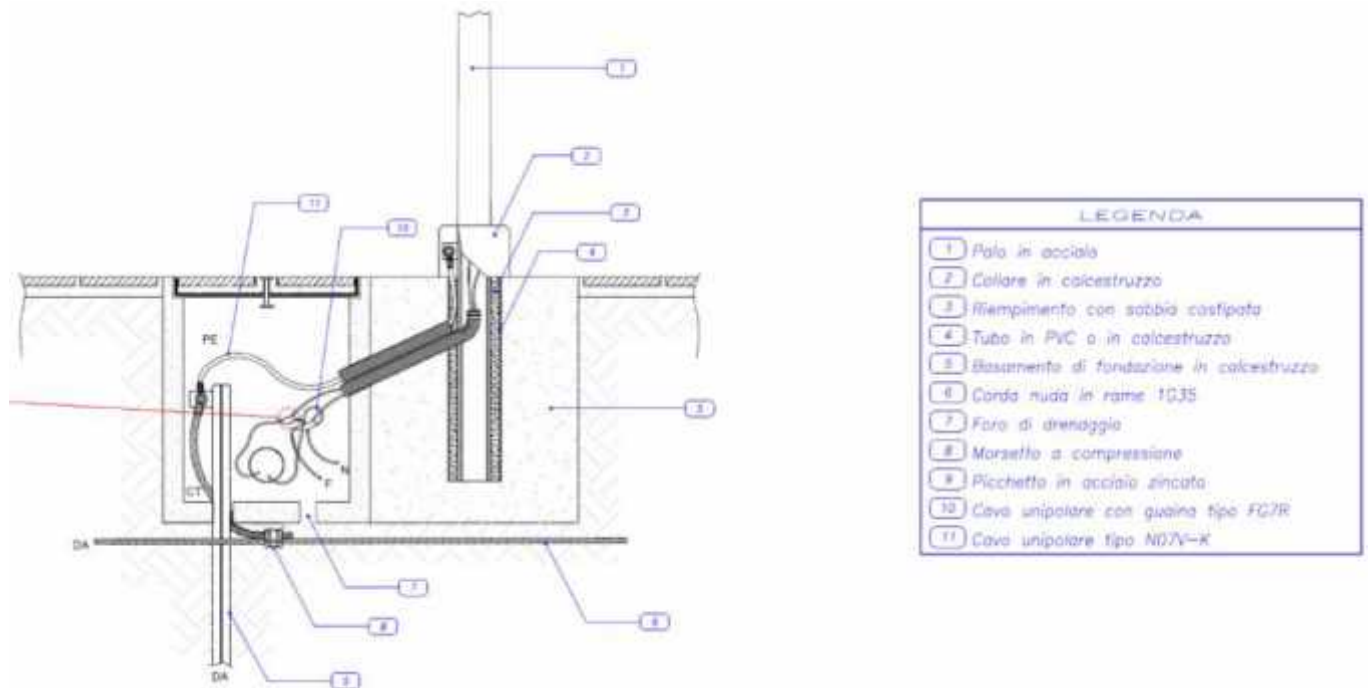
particolare del collegamento tra pozzetto e palo e vista del plinto di fondazione
